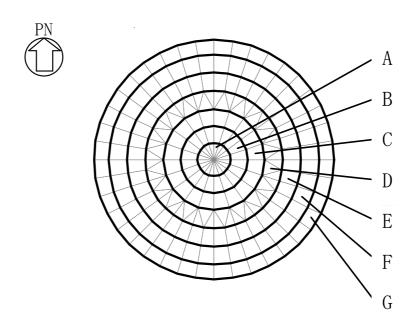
原子炉格納容器底部コンクリートマットの配筋領域
